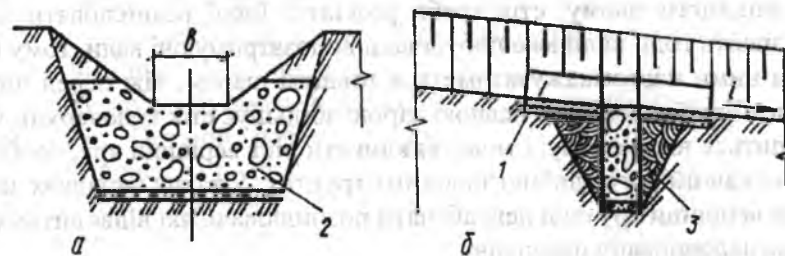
Стінка в ґрунті: а – поперечний переріз; б – поздовжній переріз; 1 – залізобетонні плити; 2 – тіло стінки; 3 – замок з глини
